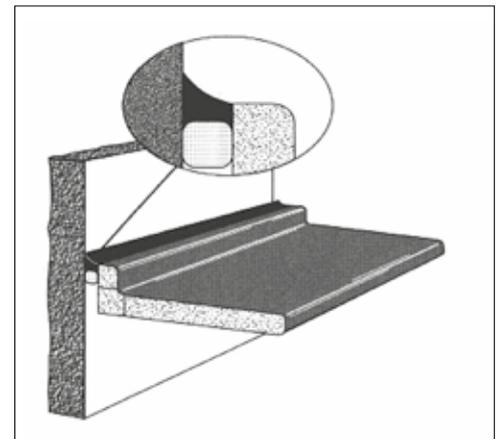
Wandanschluss einer hochgezogenen Arbeitsplatte
